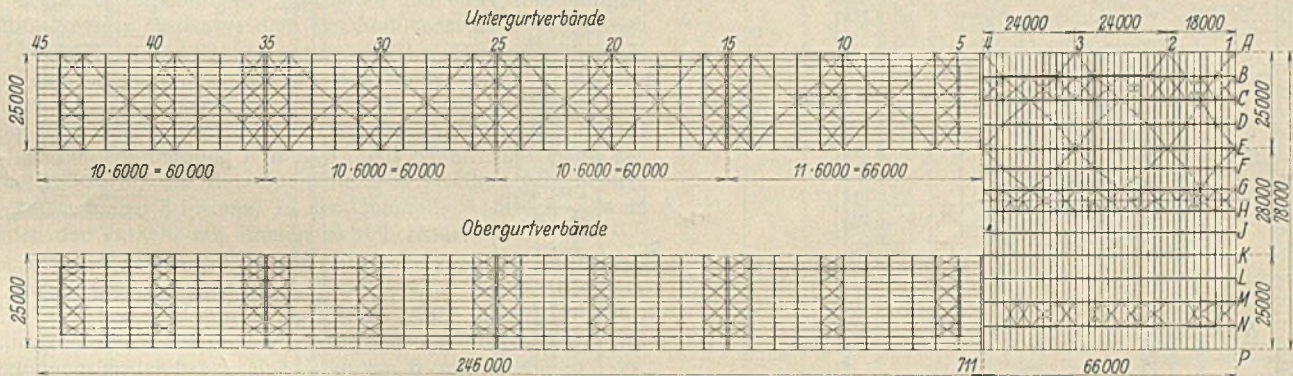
Dachgrundriß der Schmiedewerkstatt.
